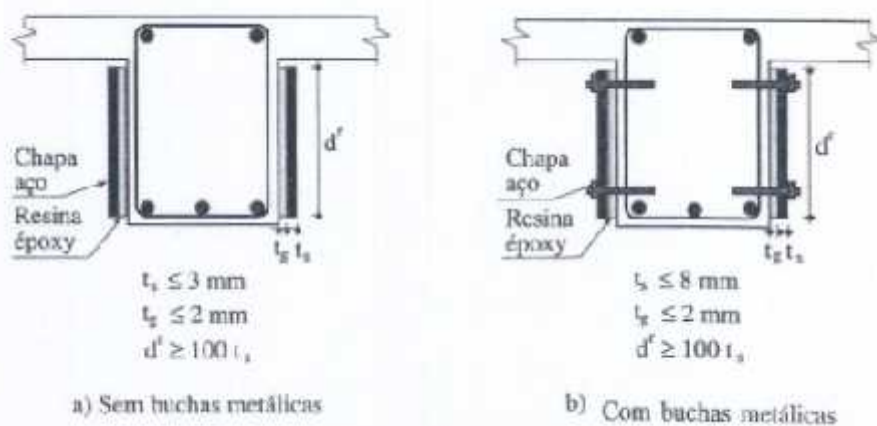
chapas metálicas para reforço estrutural (sousa e ripper, 1998)
